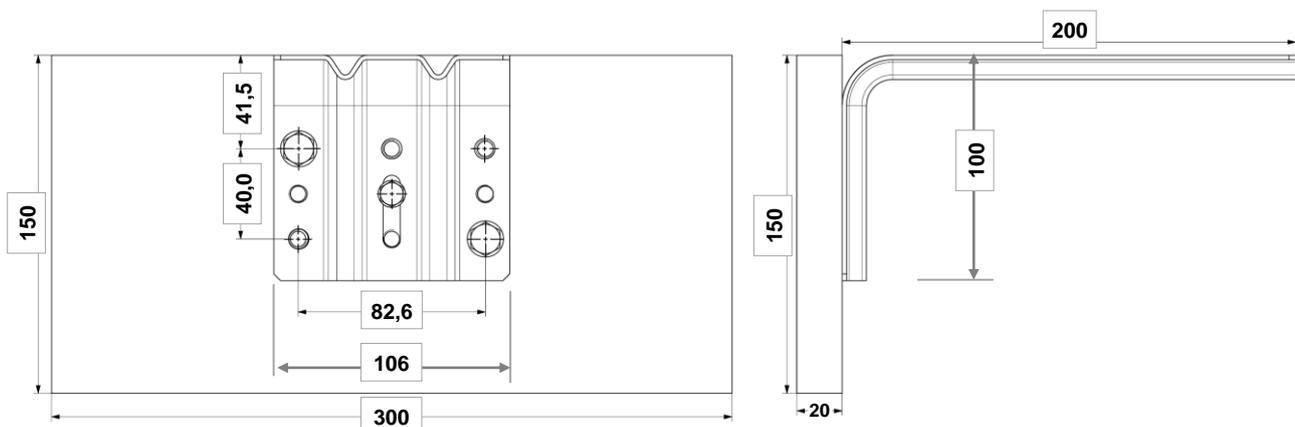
geprüfter Montagewinkel mit Aufspannplatte
